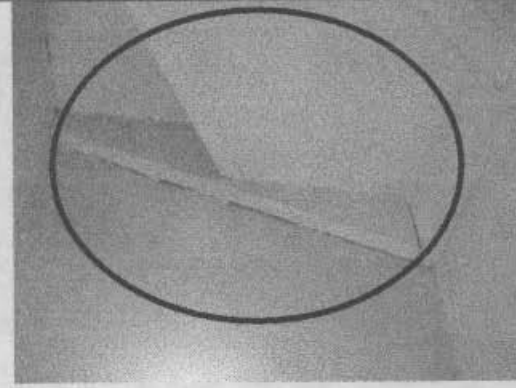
Dilatación de la escalera con el muro Occidental de la edificación.
